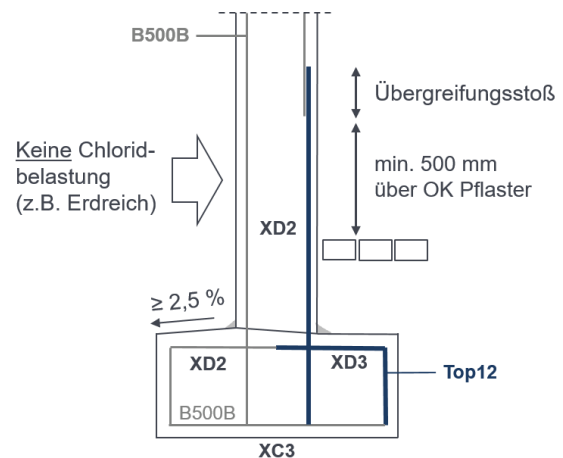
Top12-Ausführungsvariante „Wand/Fundament“ ohne Oberflächenschutzsystem oder Abdichtung, Fundament an der Oberseite bewehrt (Quelle: Steeltec AG)
